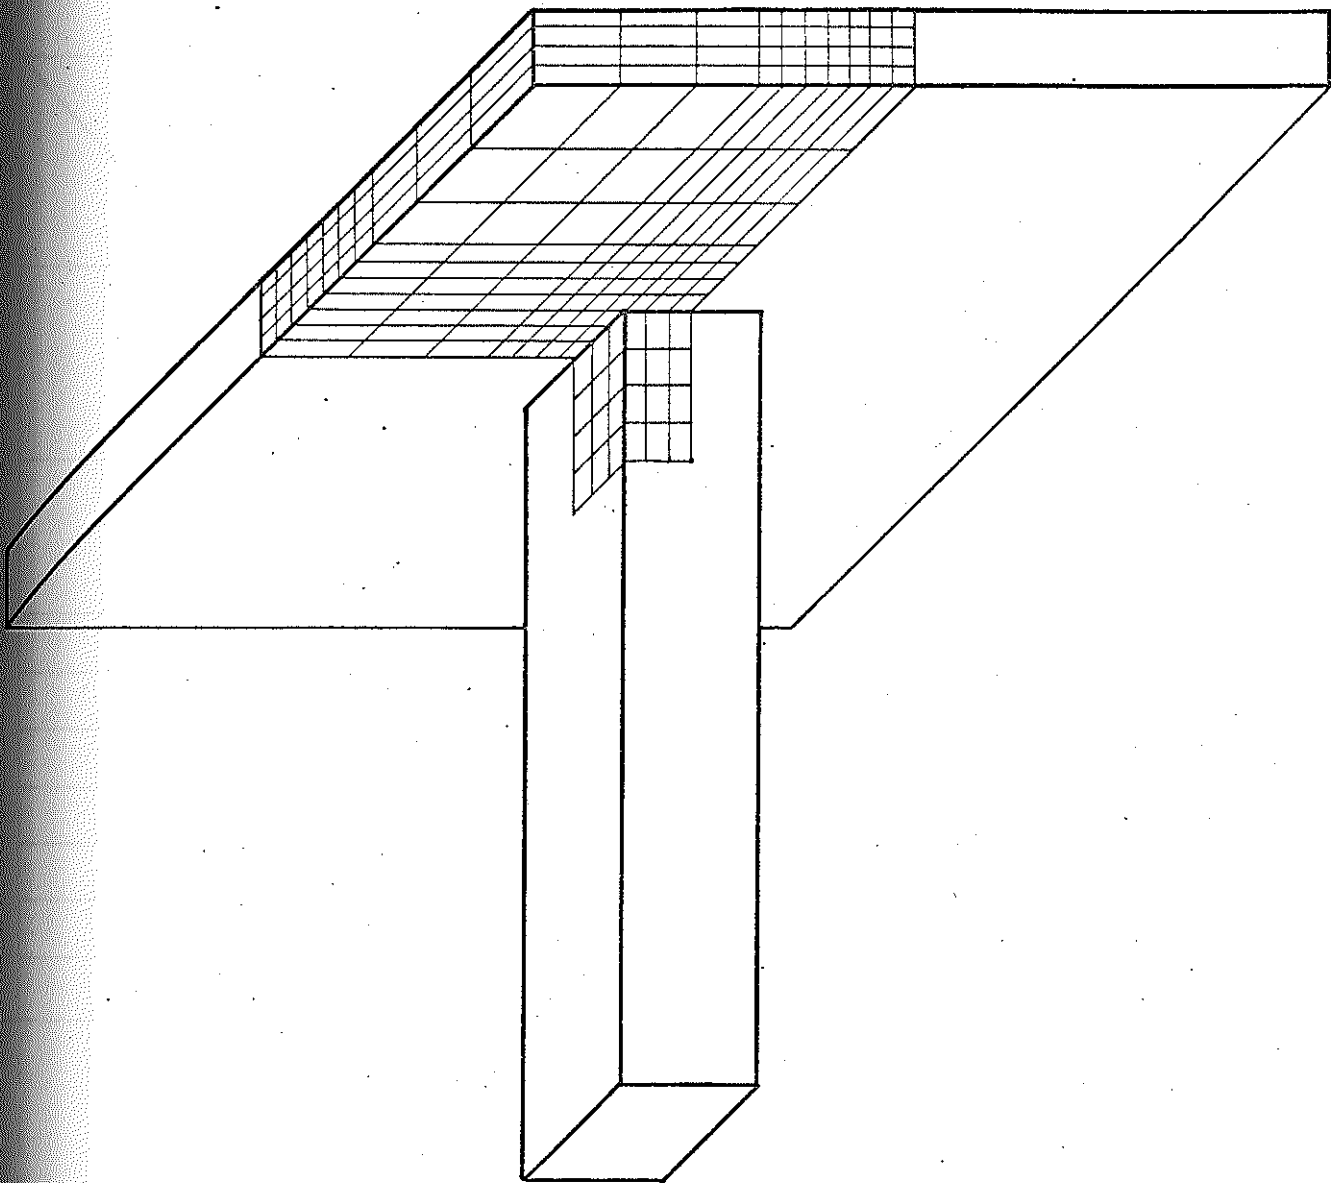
VISTA INFERIOR DO PILAR EM ANÁLISE
